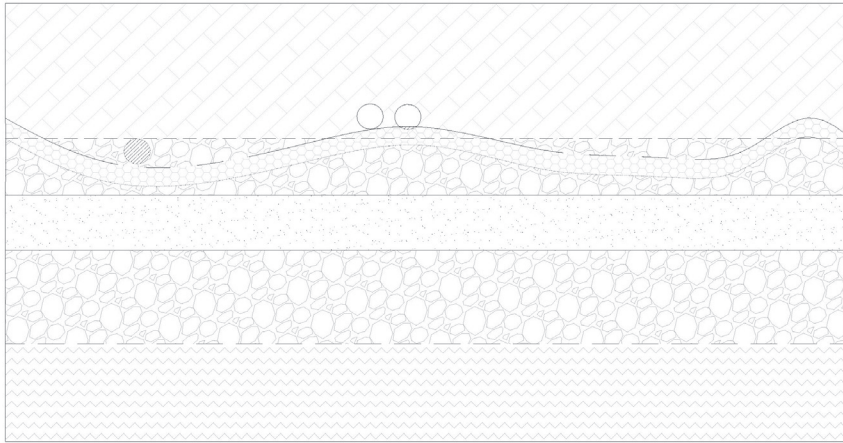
Paraqitje skematike e plazhit në plan dhe në profil.
